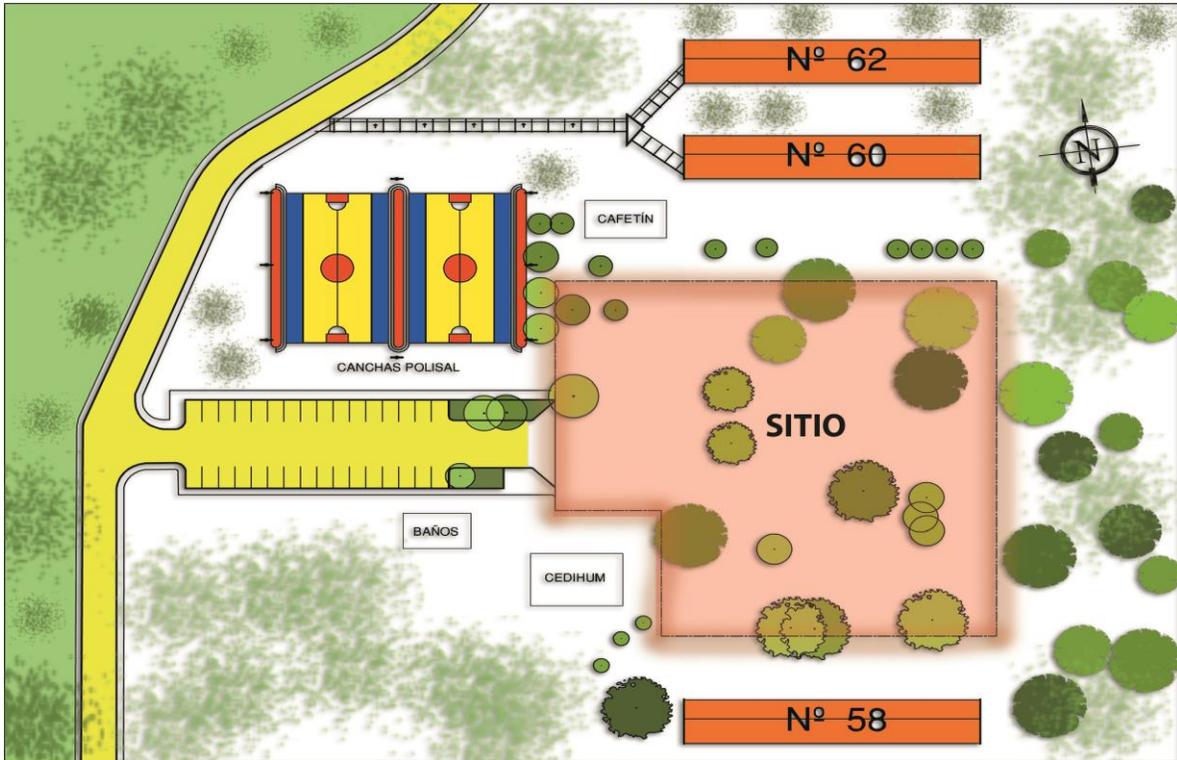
Plano de árboles del sitio. Fuente propia
